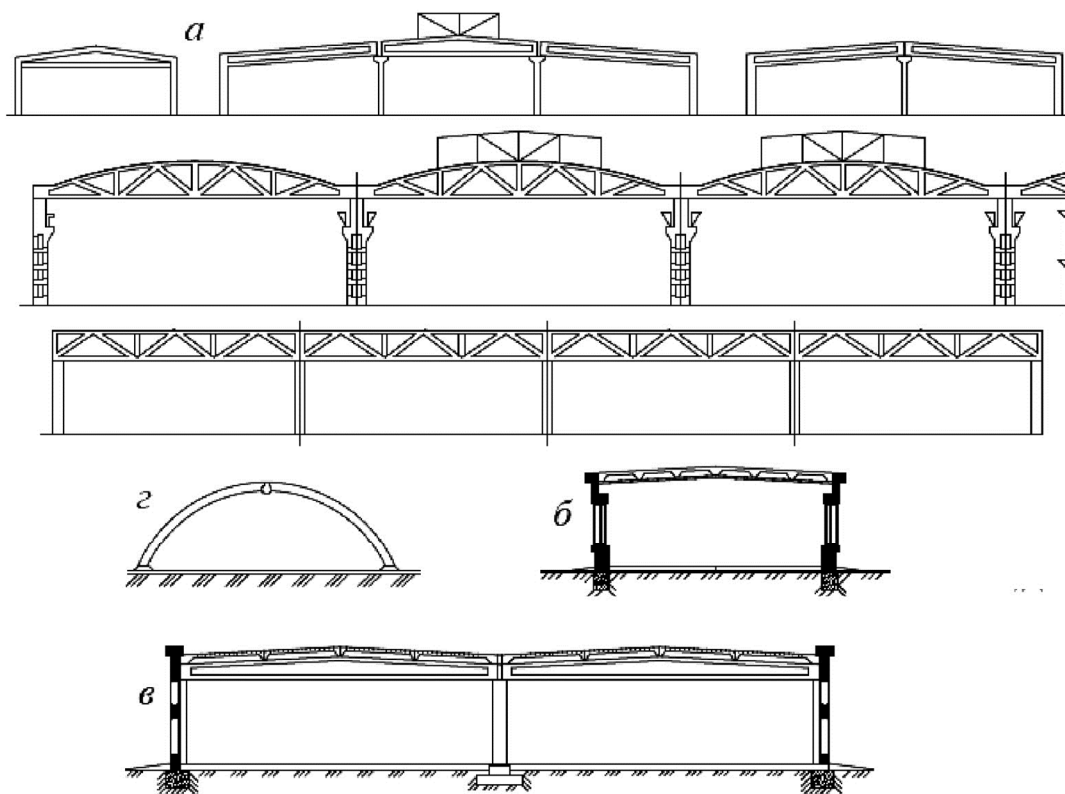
Конструктивные схемы одноэтажных промышленных зданий: а – однопролетного, двухпролетного и трехпролетного с применением двускатных балок, многопролетных с применением ферм со скатной кровлей и с плоской кровлей; б – бескаркасные; в – с неполным каркасом; г – шатровые
